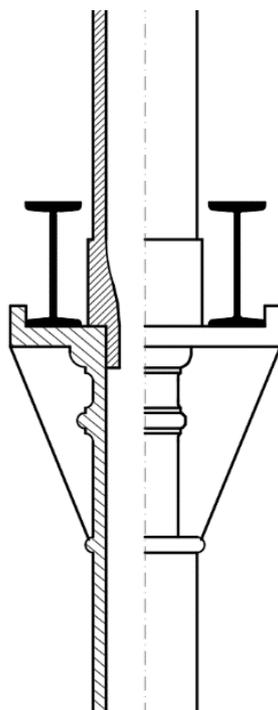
Unión de pilar a pilar en Fontecha y Cano de Albacete.
